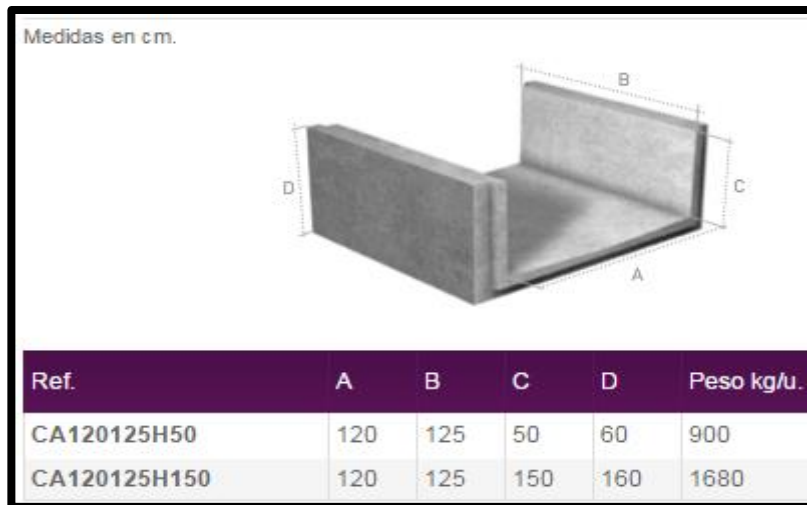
Dimensiones de una sección rectangular prefabricada. Fuente: GLS Prefabricados
